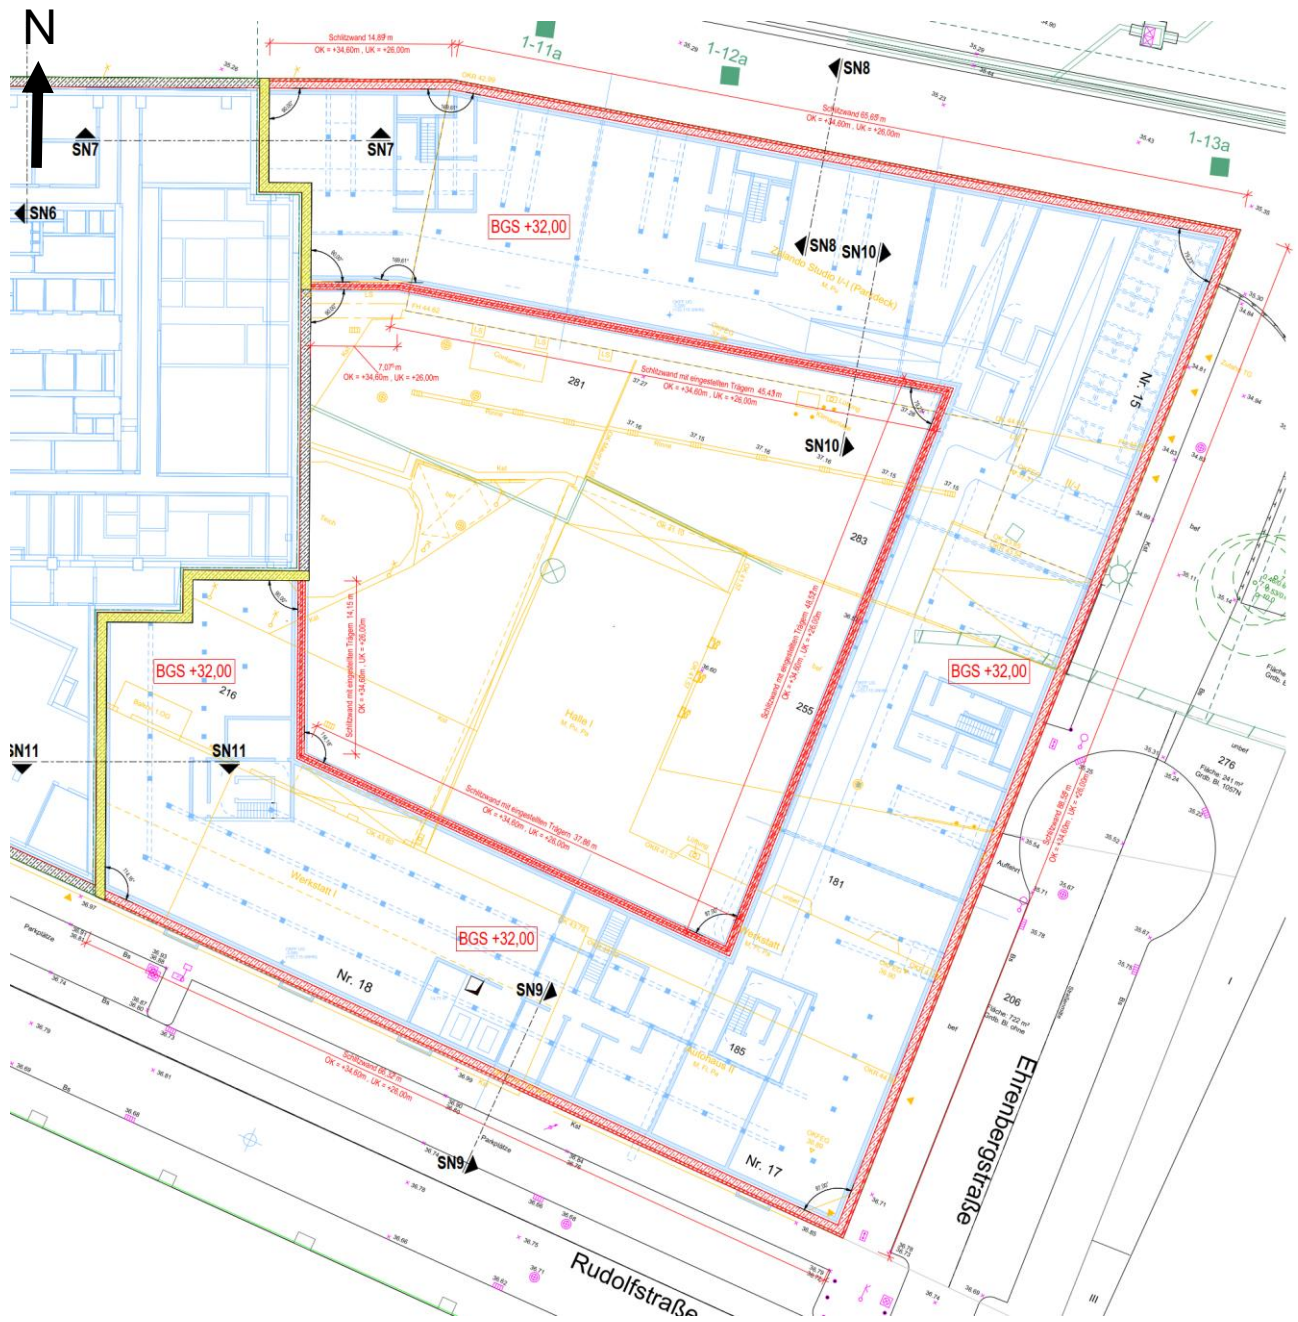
Grundriss Baugrube Bauteil B und C (aus [U 7])
